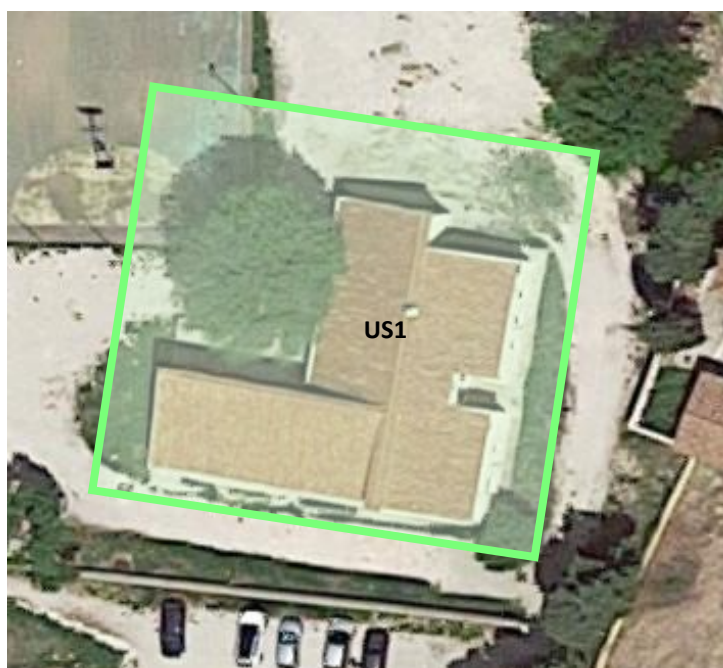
Suddivisione dell'edificio in Unità Strutturali
